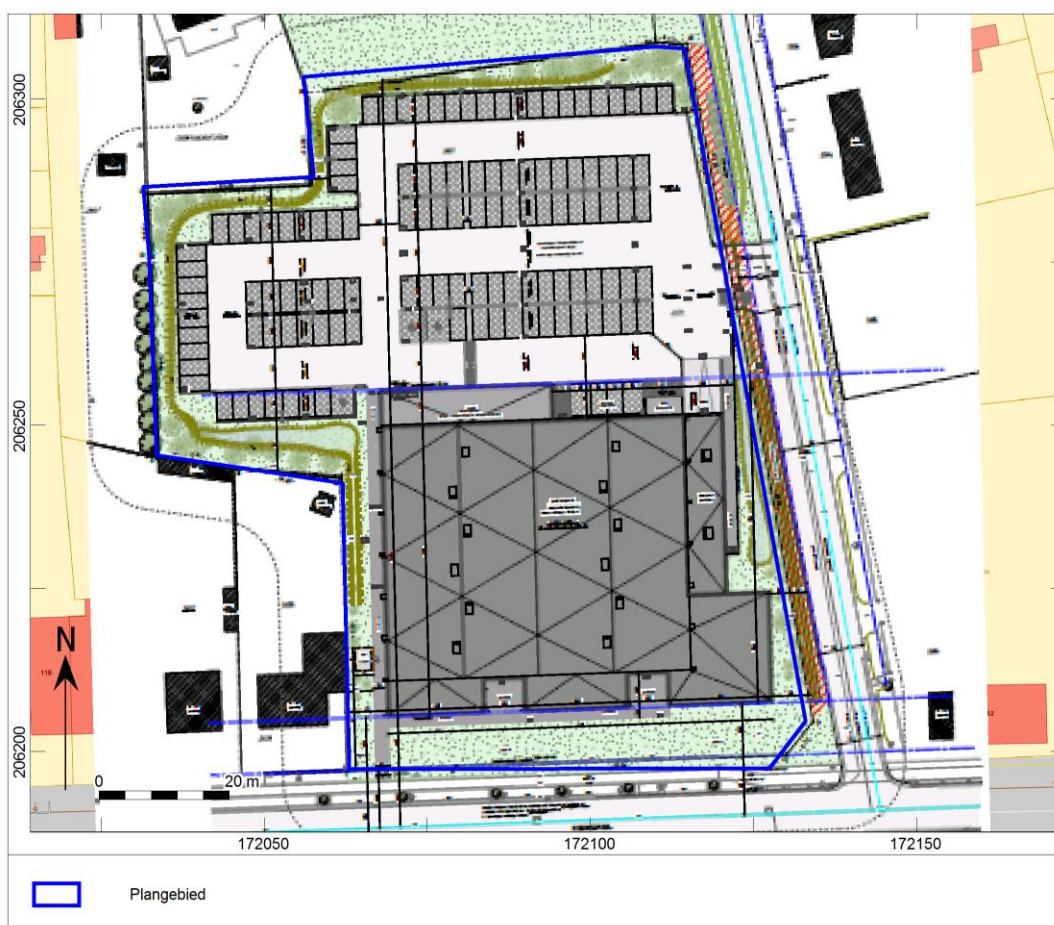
Grondplan van het plangebied met aanduiding van de riolering en de infiltratievoorzieningen.
